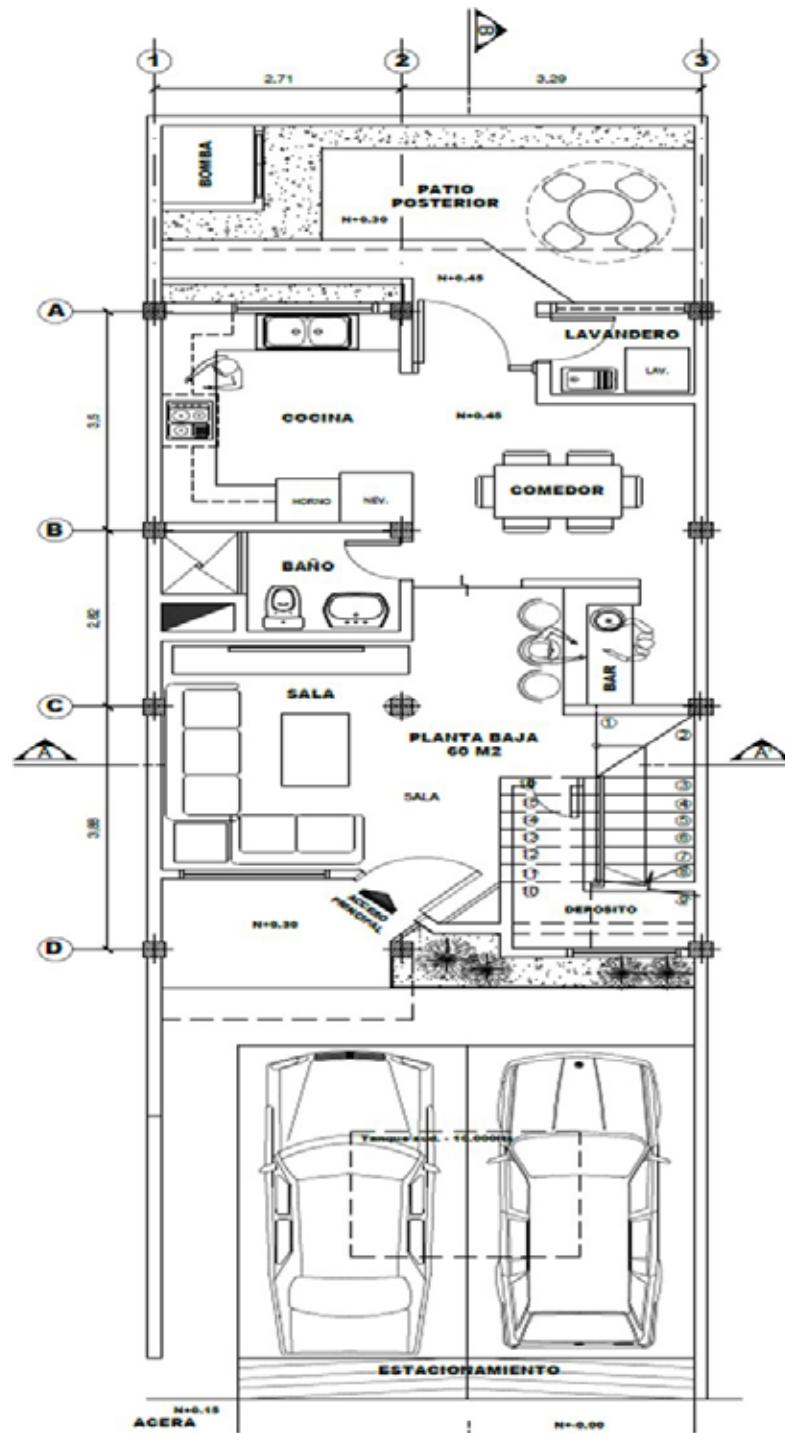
Plano Arquitectónico de Planta Baja Tipo.
